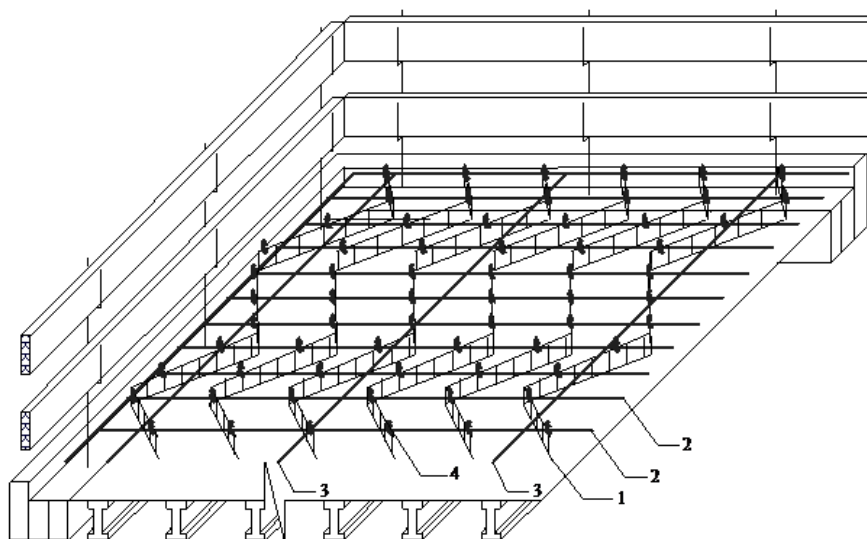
Устройство верхней арматурной сетки: 1 поддерживающие каркасы; 2 поперечные арматурные стержни верхней сетки, уложенные с проектным шагом; 3 продольные арматурные стержни, уложенные с увеличенным пролетом; 4 закрепление верхних поперечных стержней к поддерживающим каркасам с помощью вязальной проволоки
